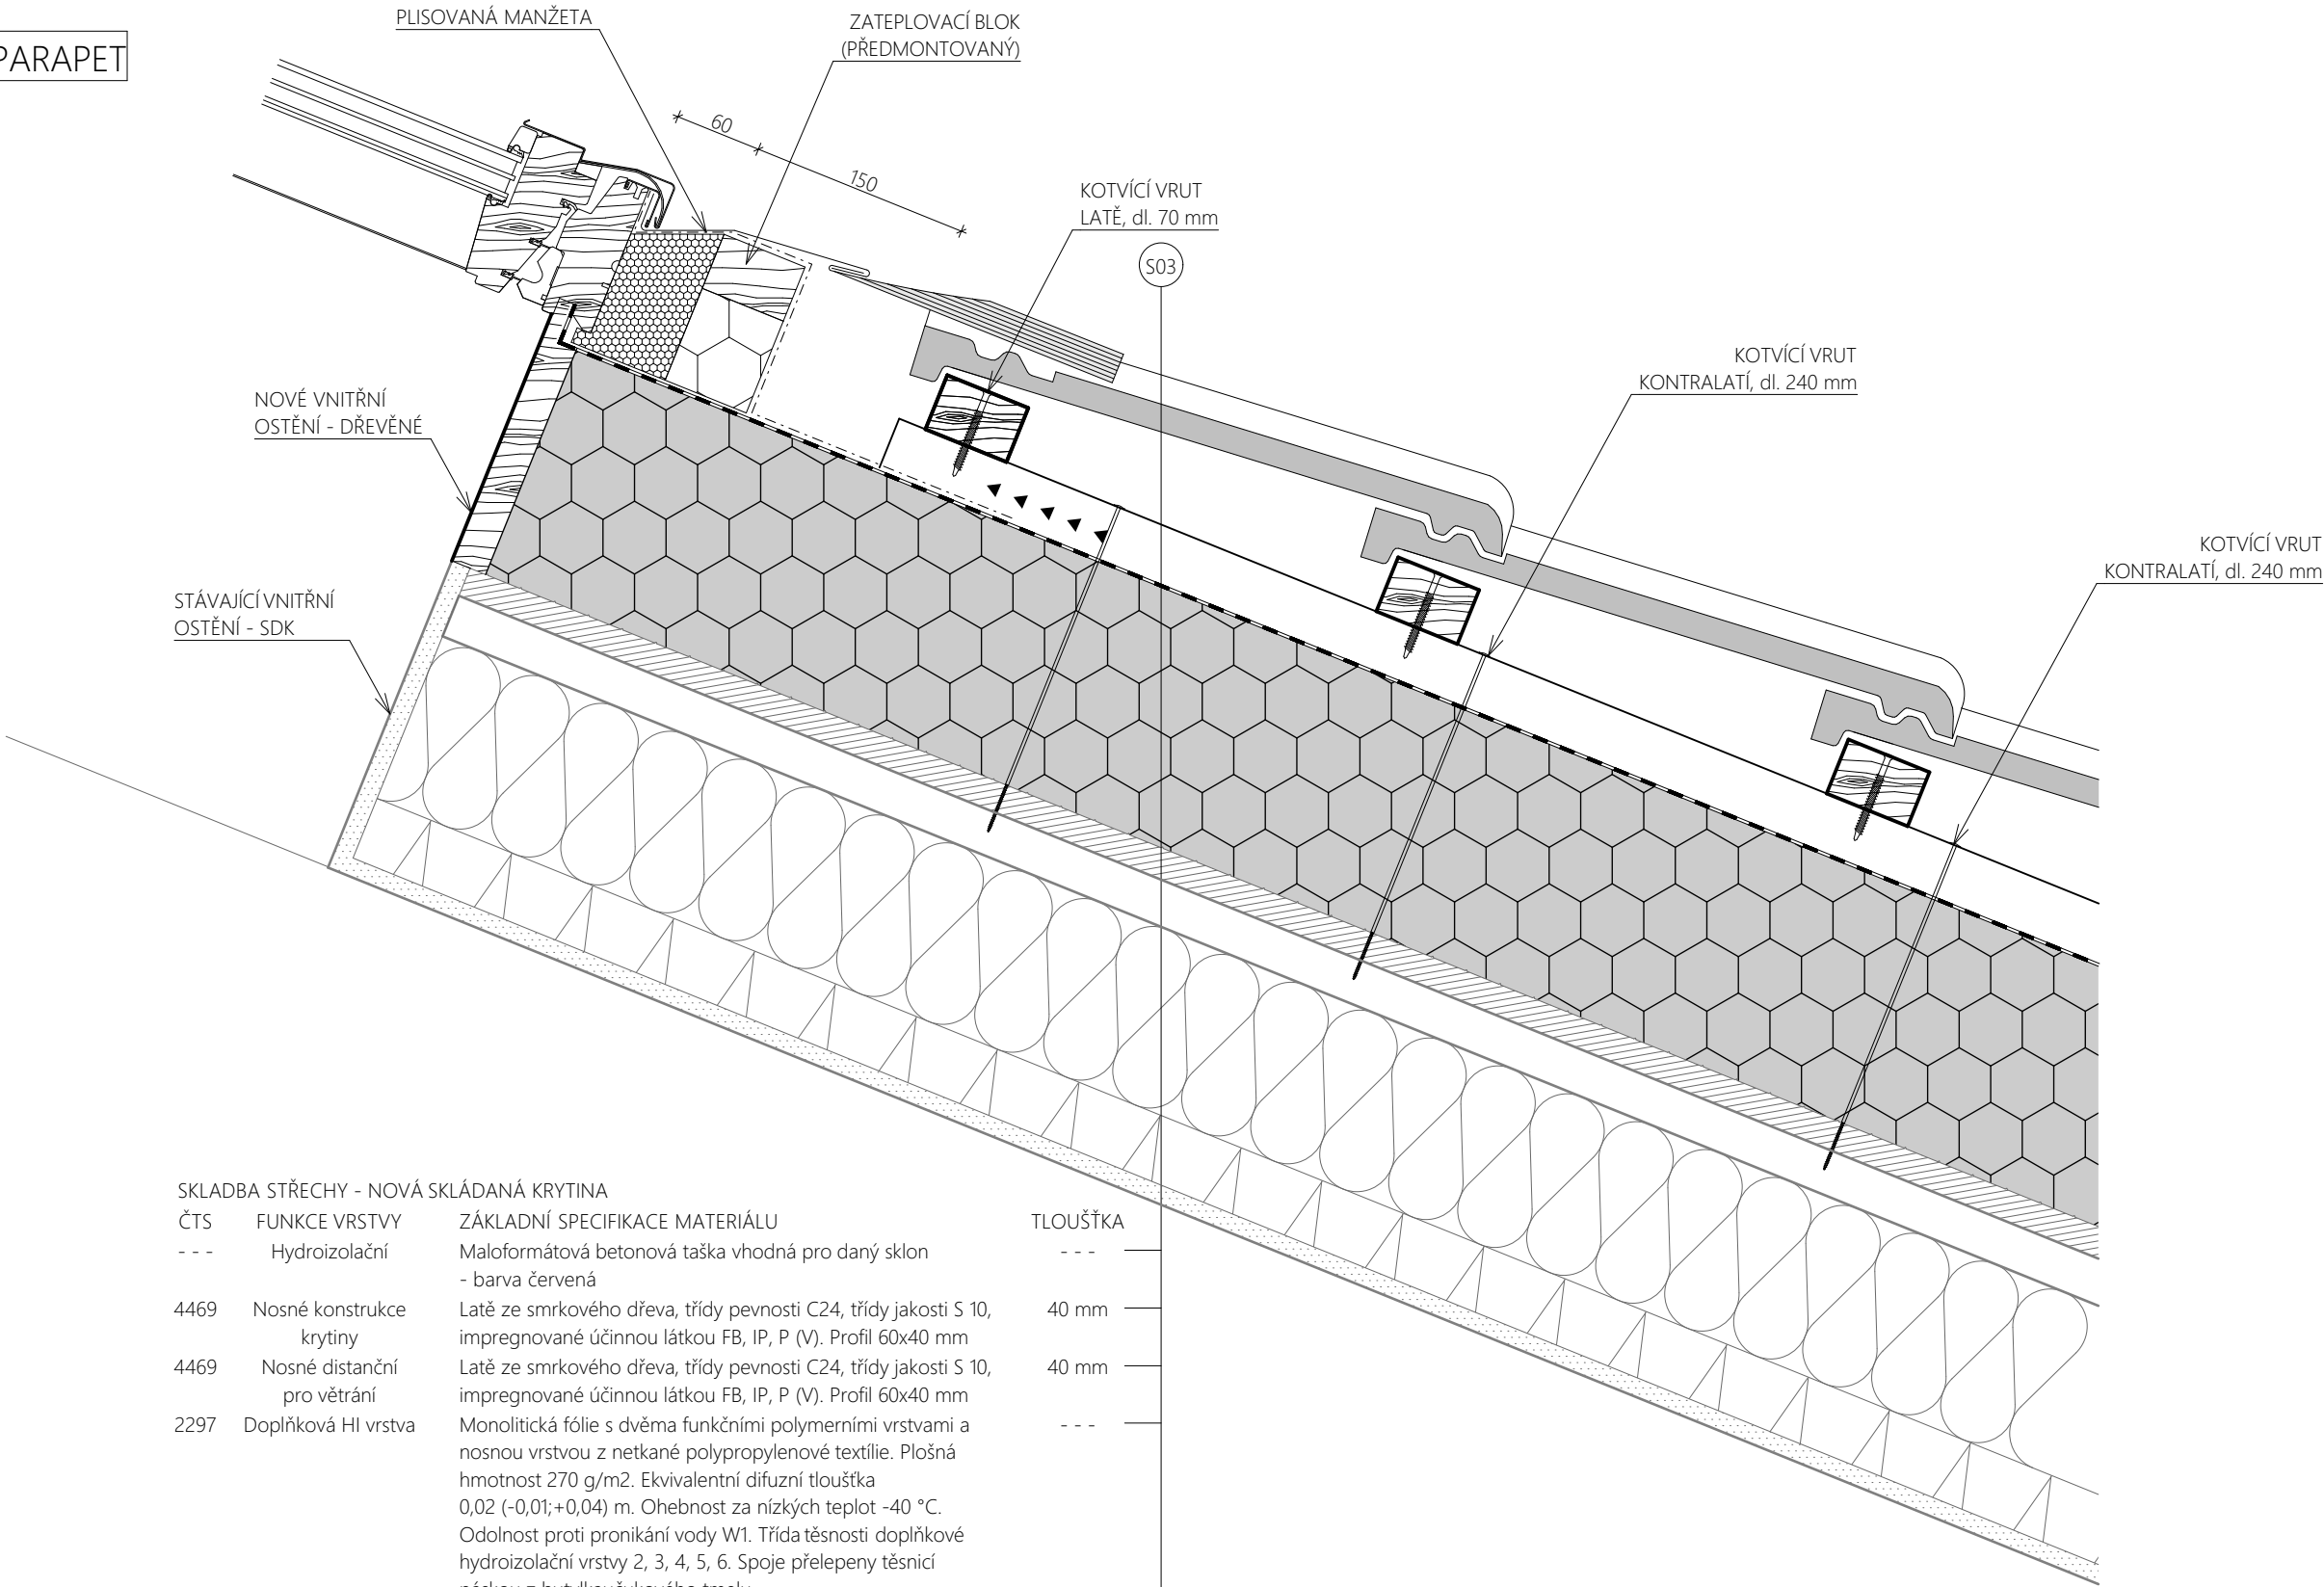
DETAIL STŘEŠNÍHO OKNA - NADPRAŽÍ
